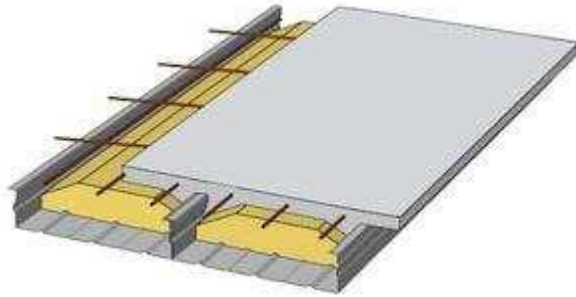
Laje mista formada por chapas de aço dobradas, blocos de lã de rocha e uma capa de concreto (MESQUITA, 2016)
